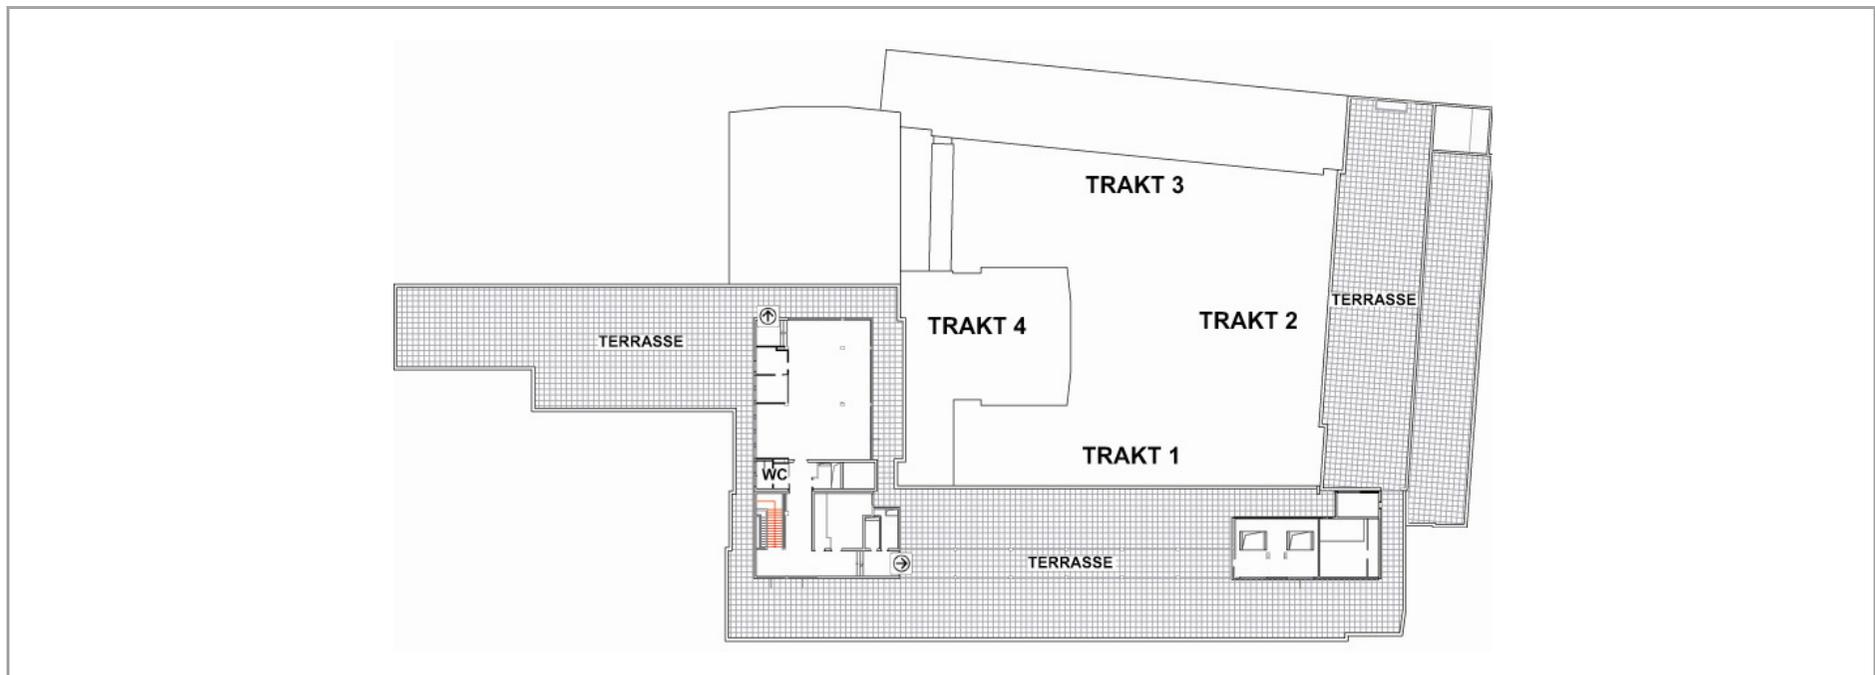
Gußhausstraße 27-29, Sechstes Obergeschoß (Ossberger, D. 2009 nach <http://www.gut.tuwien.ac.at>)
